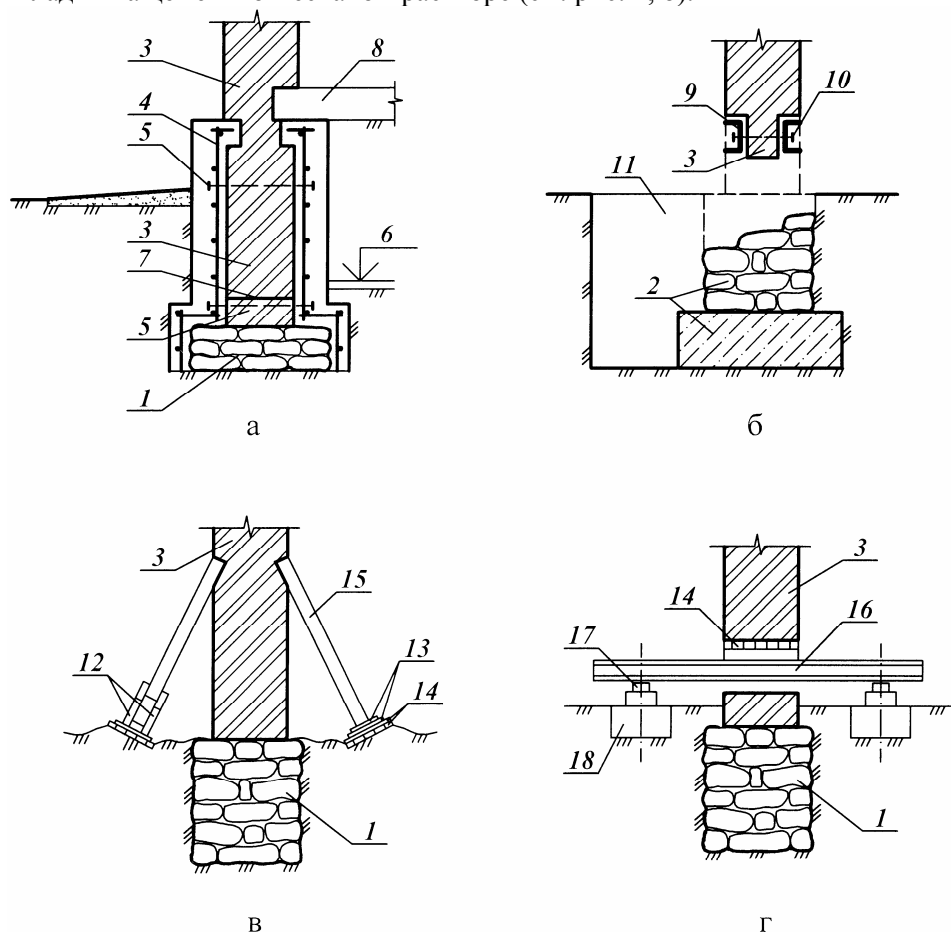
Усиление фундаментов железобетонными обоймами и путем перекладки:
